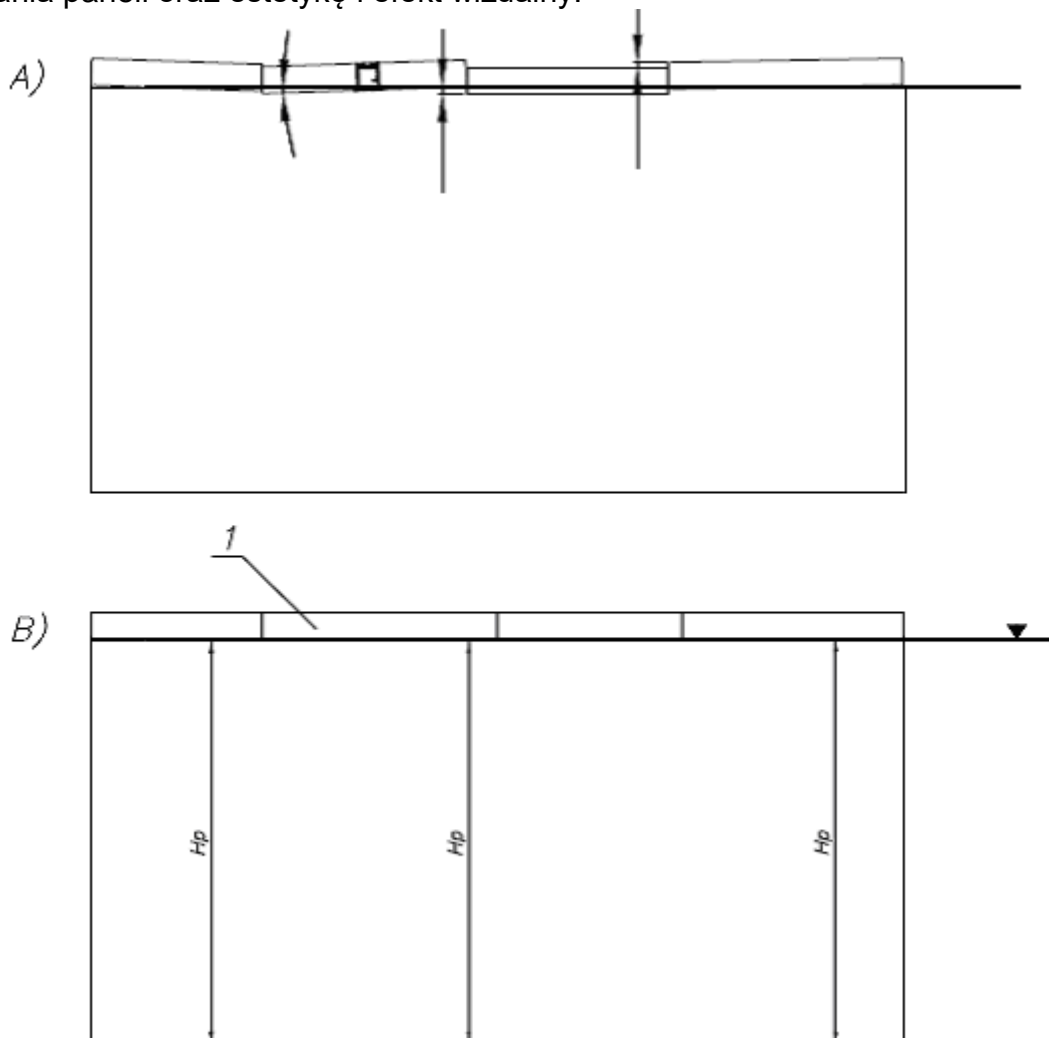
Sposób montażu i ustawienia blach serwisowych w module serwisowym dla zawieszenia 1-punktowego (przykład z torem 34-0131)
